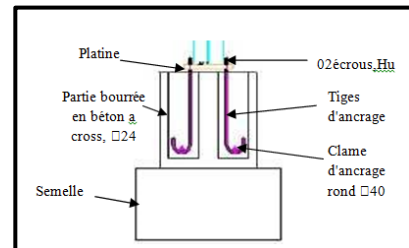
Détail n°01: Articulation pied de poteau- fondation ; Source : auteur 2019
